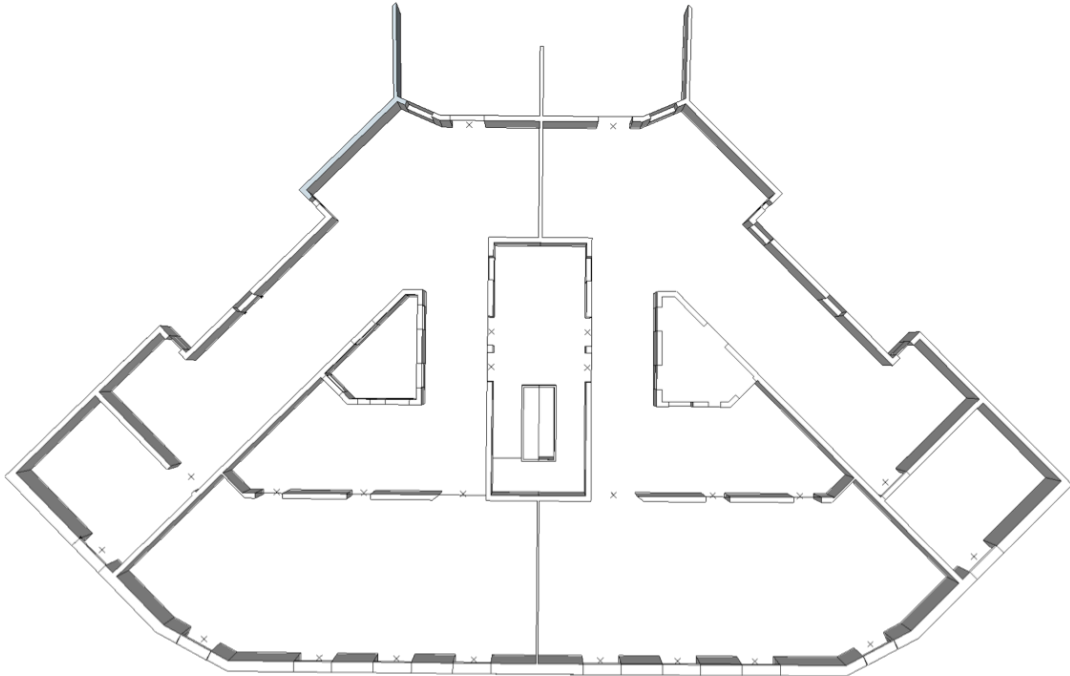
Vista en planta de planta tipo del edificio ED-04 (fuente: elaborado por el autor)
